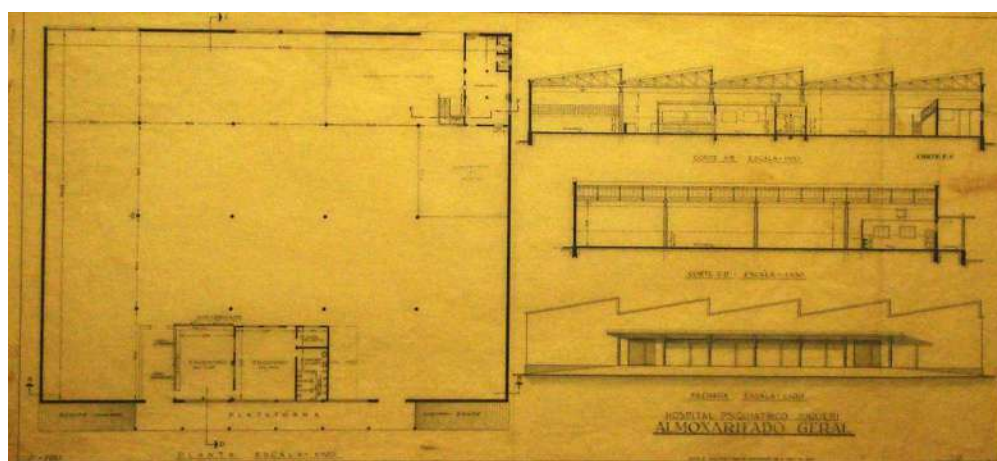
Planta, corte (mostrando o sistema de shed do telhado) e fachada (acervo SIOC)
